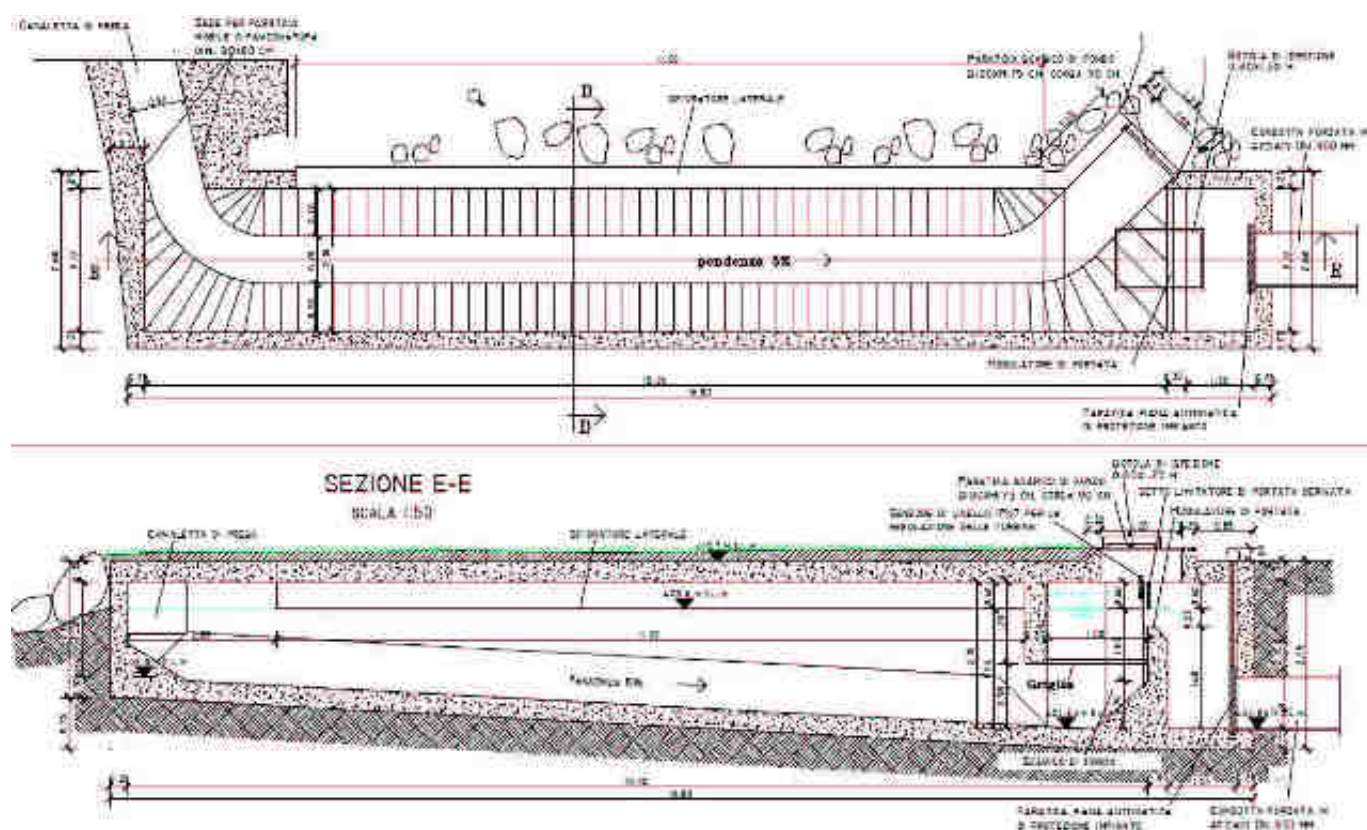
pianta e sezione longitudinale opera dissabbiatrice-modulatrice
